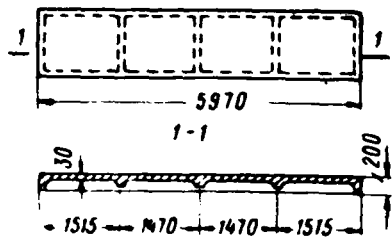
Общий вид железобетонной стеновой панели длиной 6 м серии СТ-02-10/61
